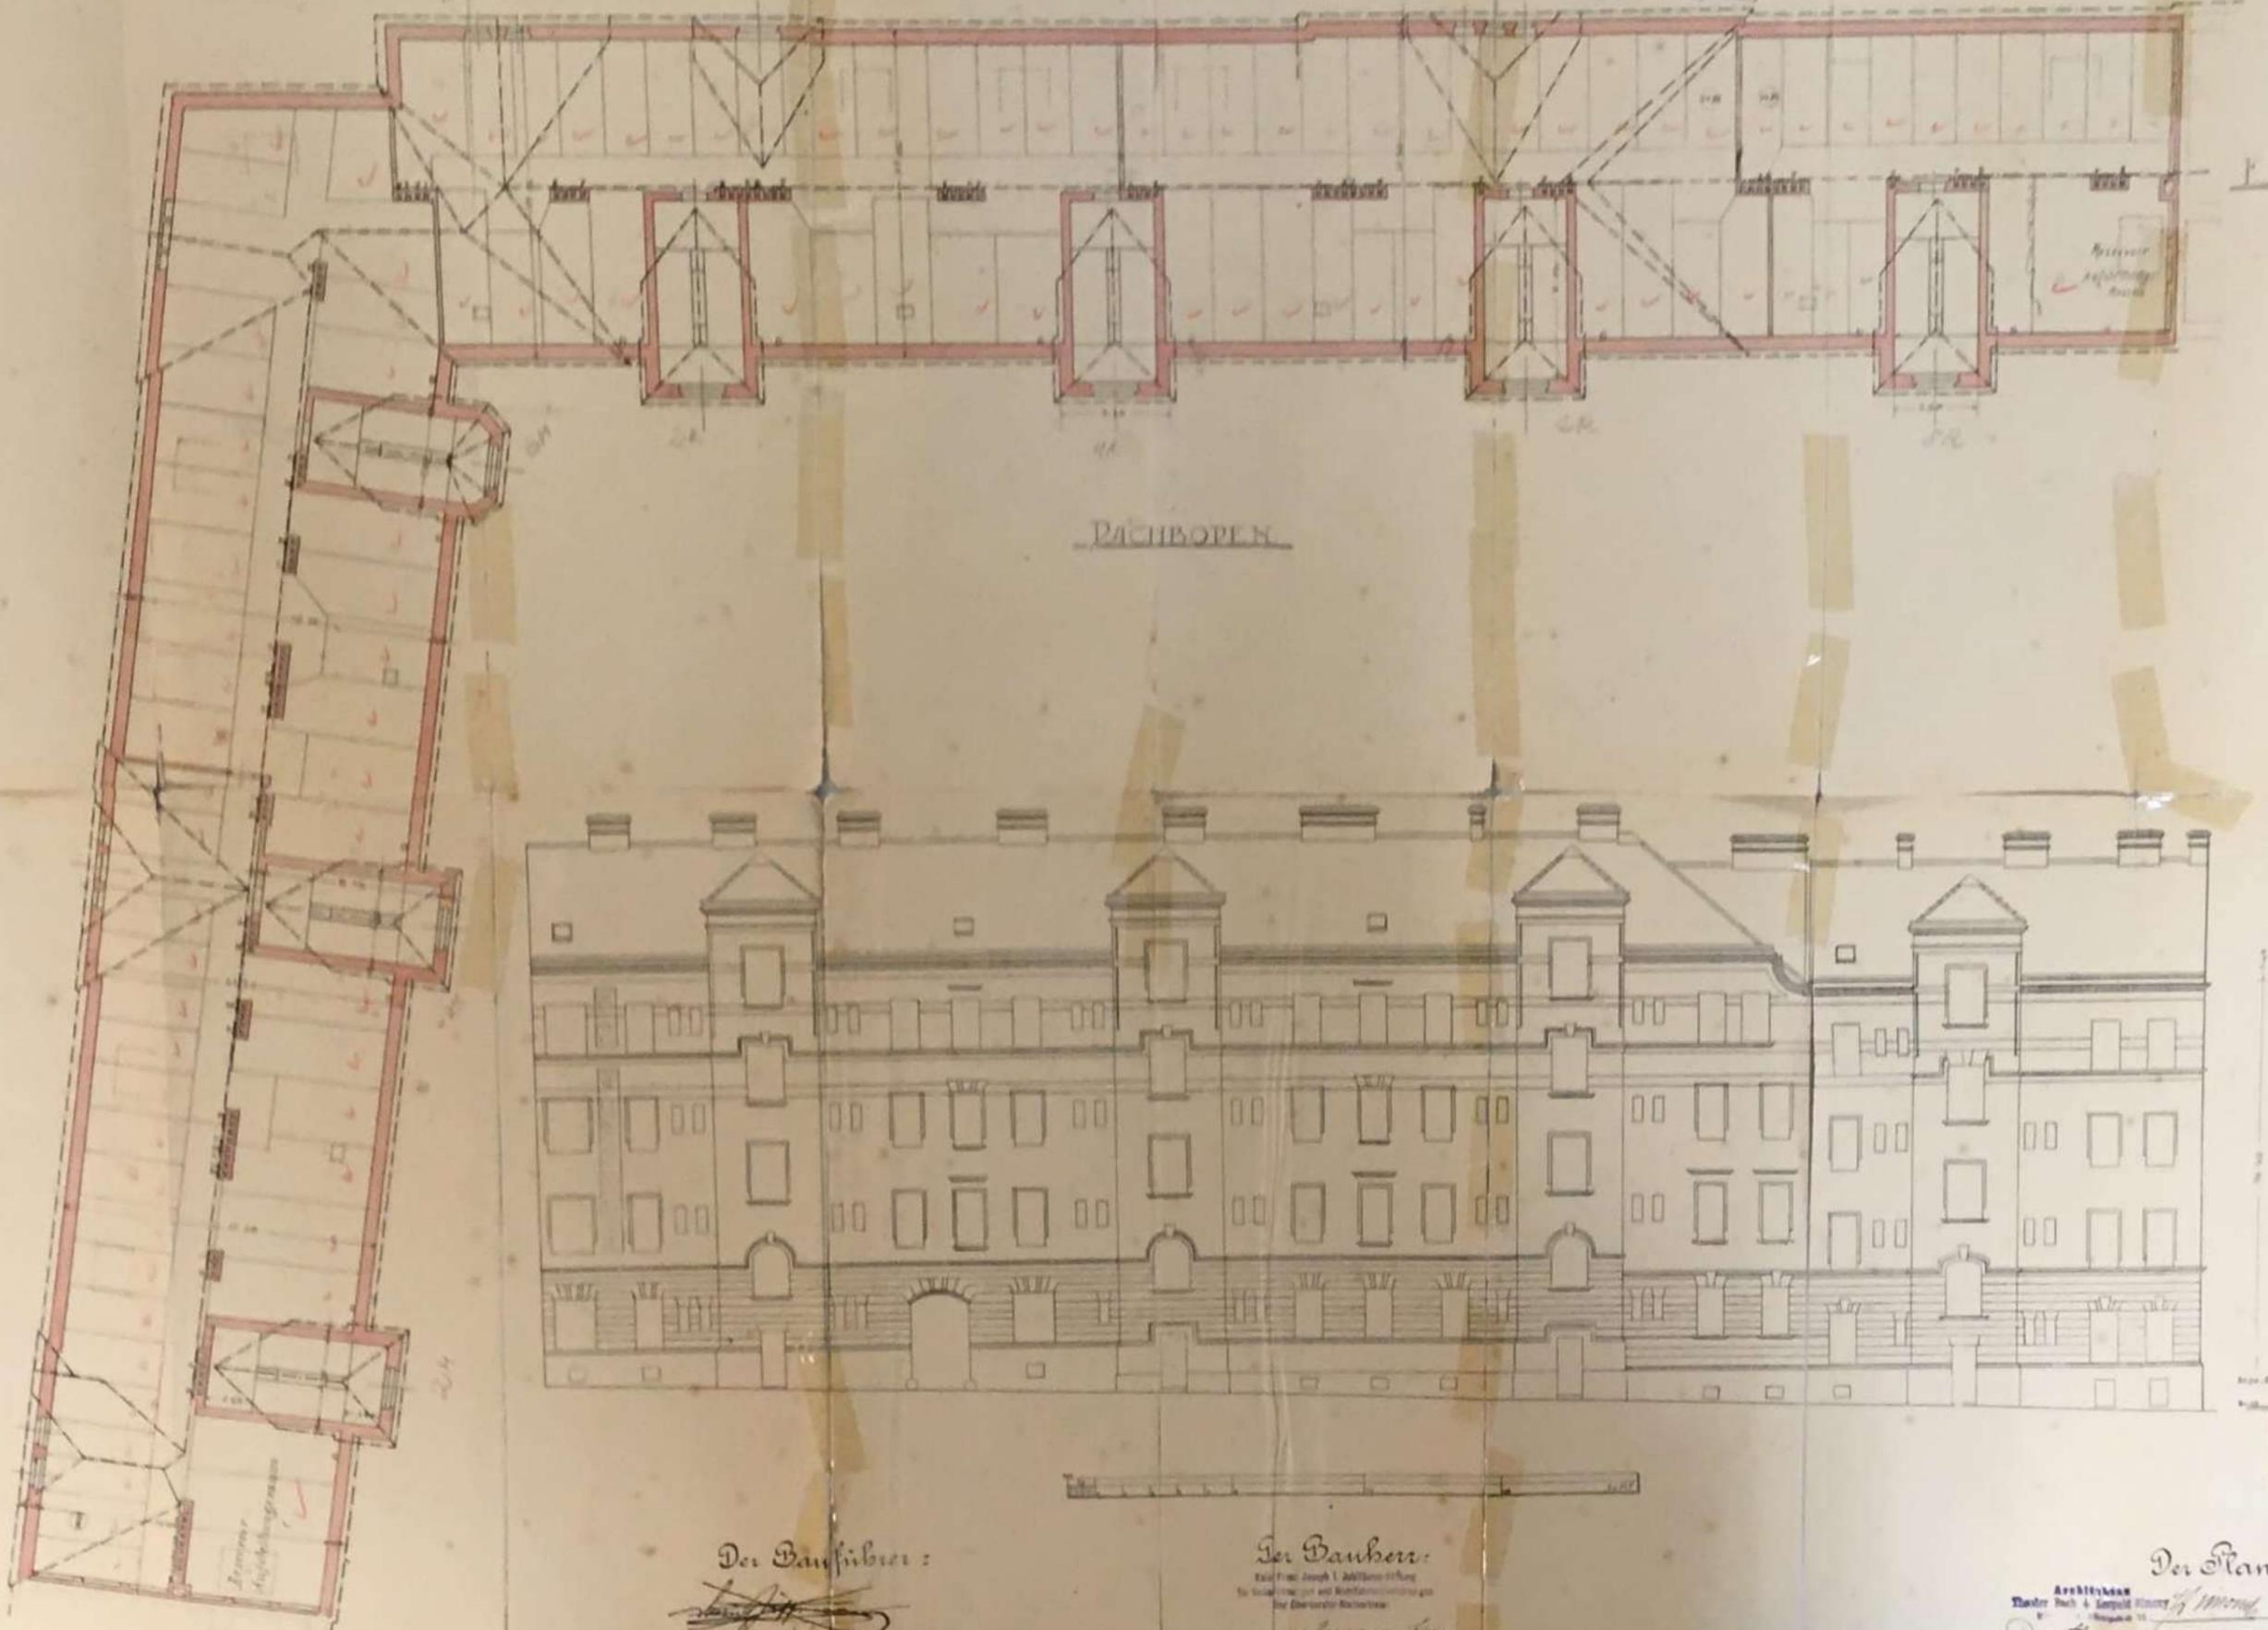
Planarchiv MA37, Regelgeschossplan aus dem Jahr 1900
